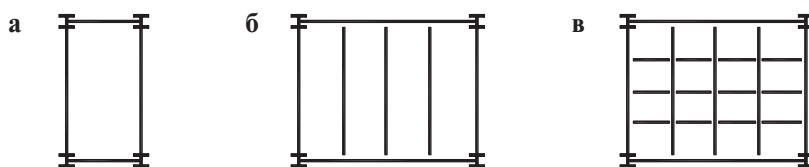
Балочные перекрытия зданий с рамными и связевыми каркасами:
